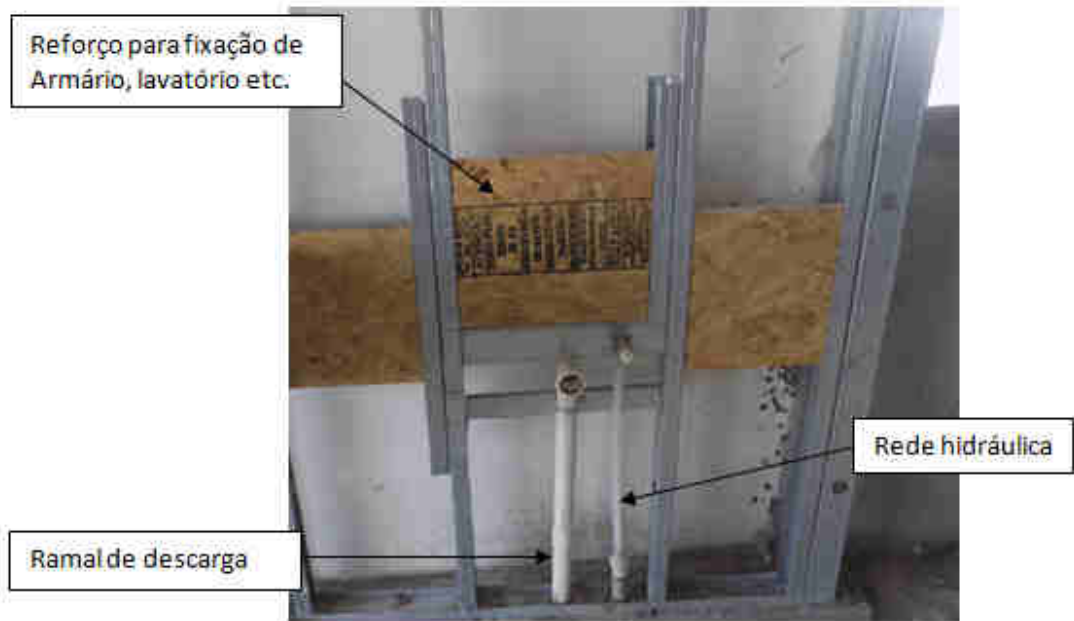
Rede sanitária e reforço para instalação de louças (Autor, 2016)
